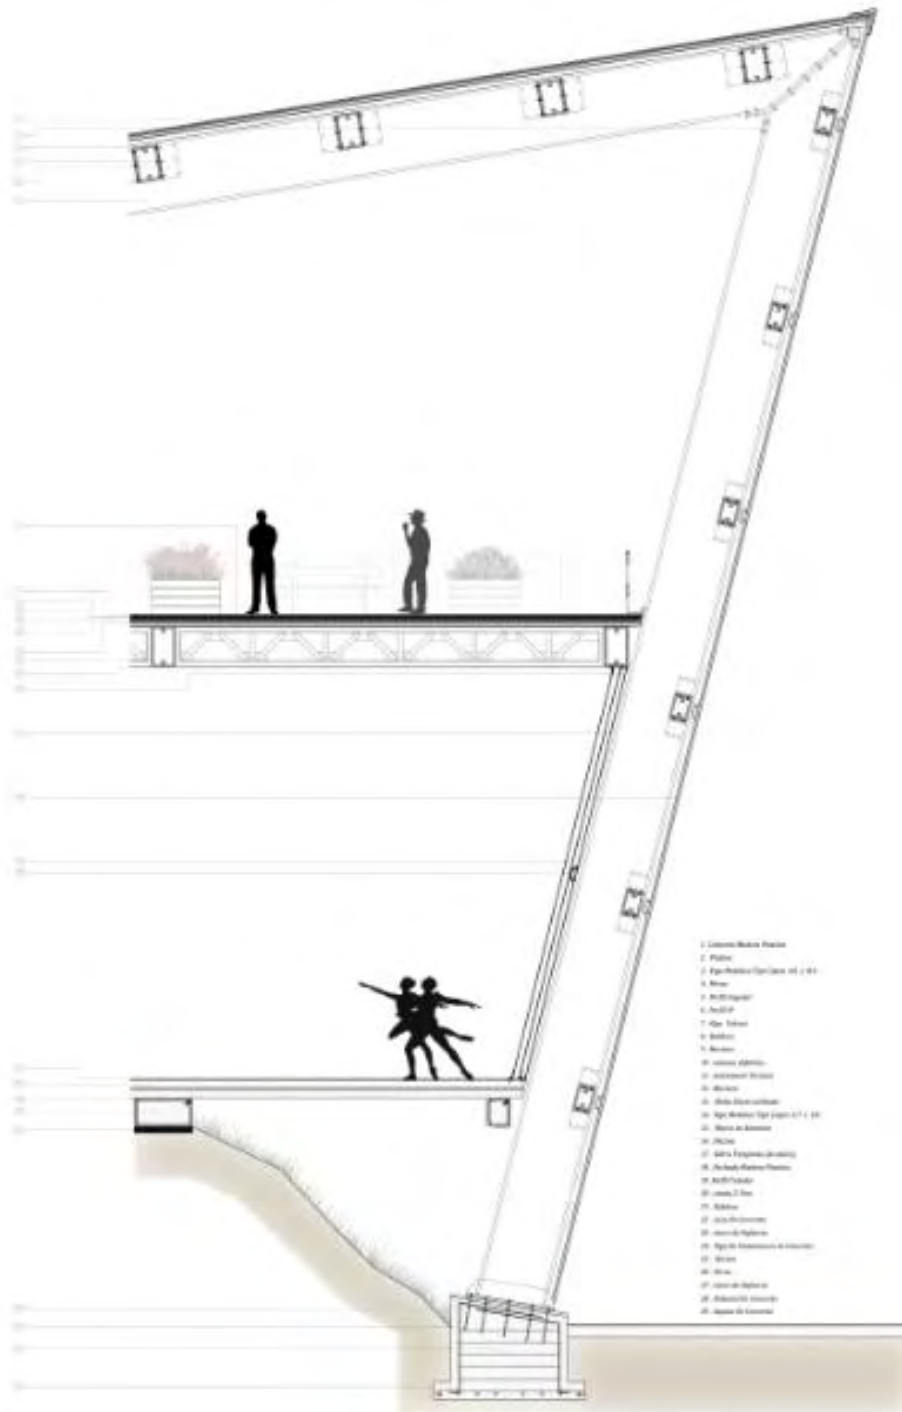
Corte Fachada 02. Fuente: Elaboración propia
